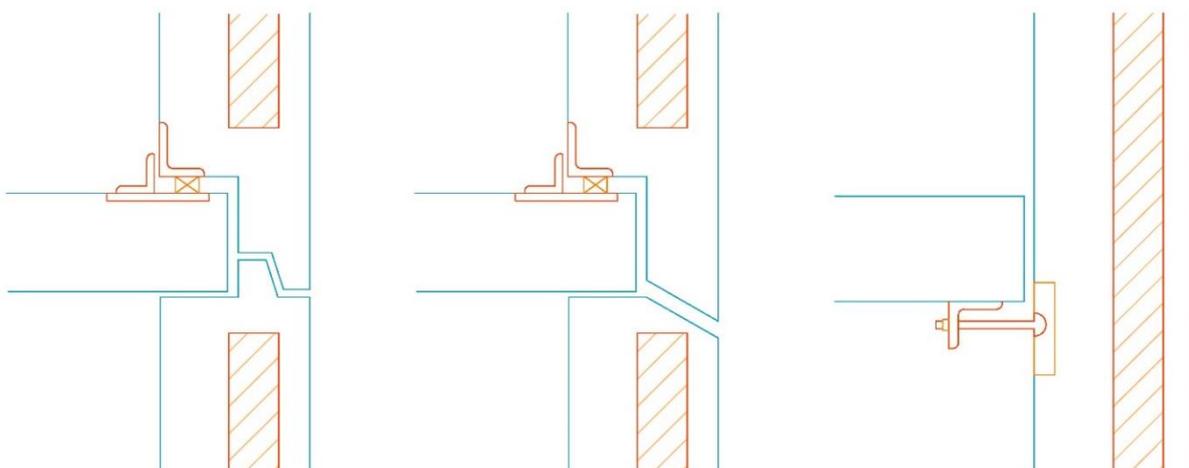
Ejemplos de juntas entre paneles de hormigón prefabricado con aislante y placas alveolares (Dibujo original)
